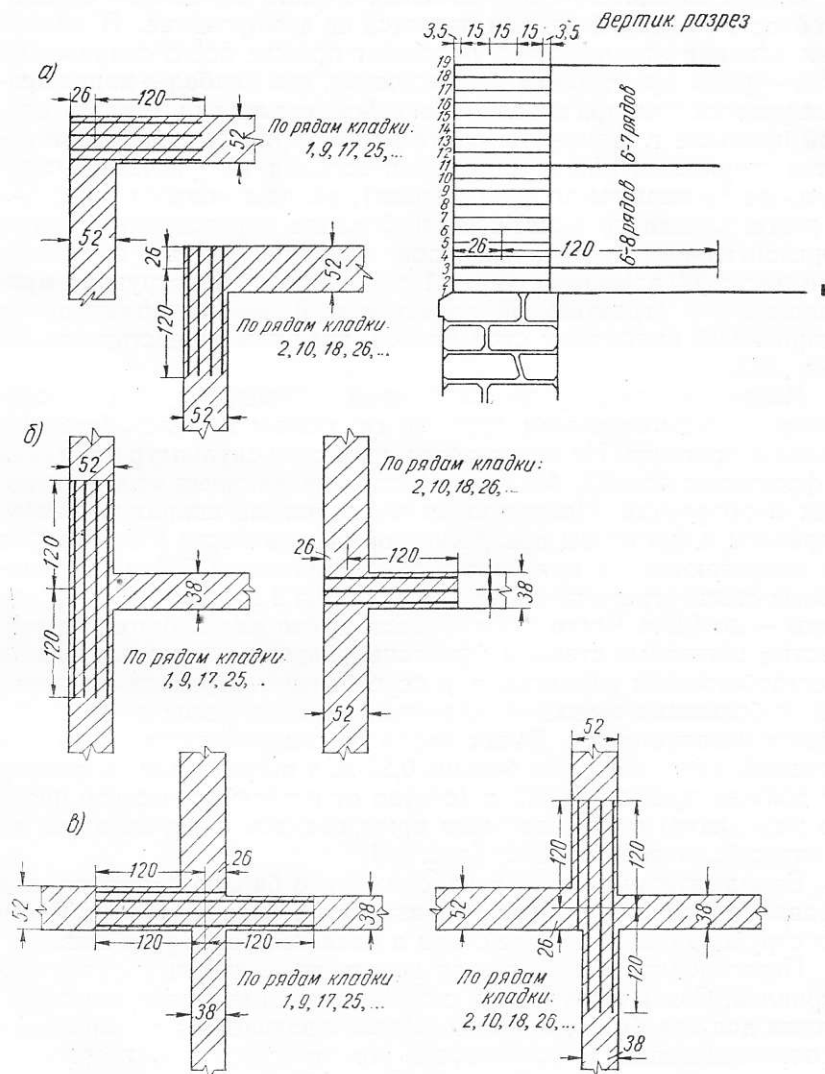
Армирование стен стержнями \varnothing 5—6 мм
